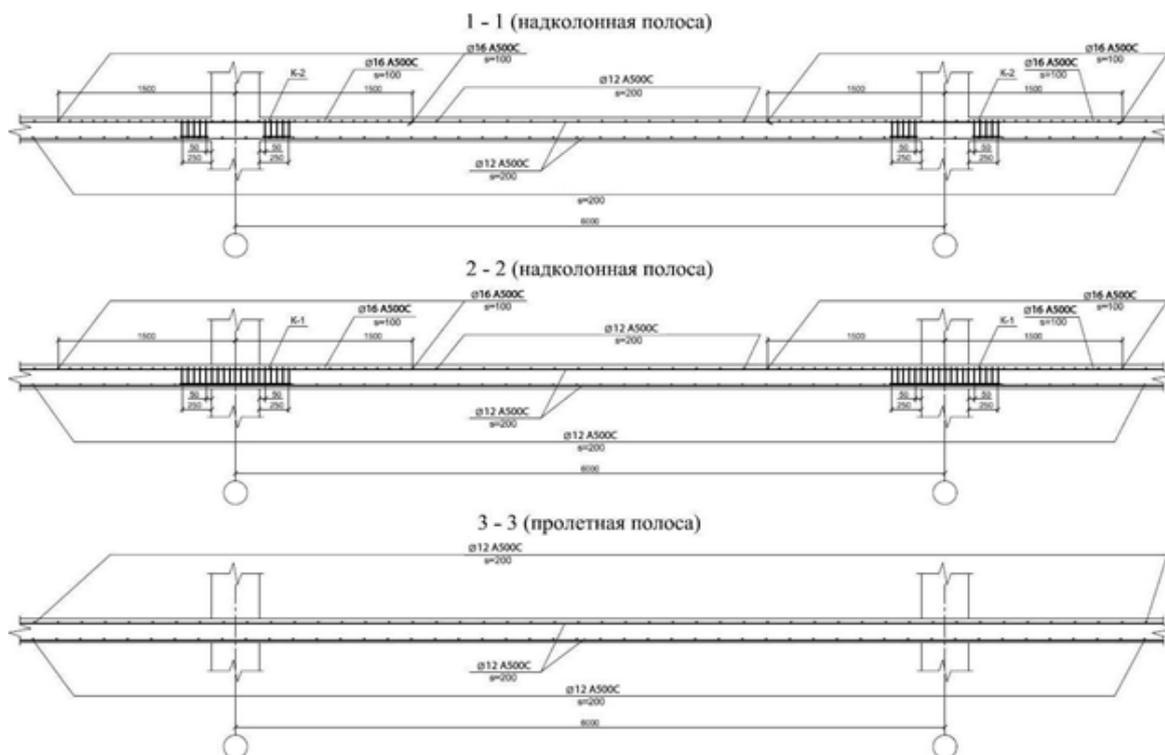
Армирование плиты перекрытия в осях 4-5
